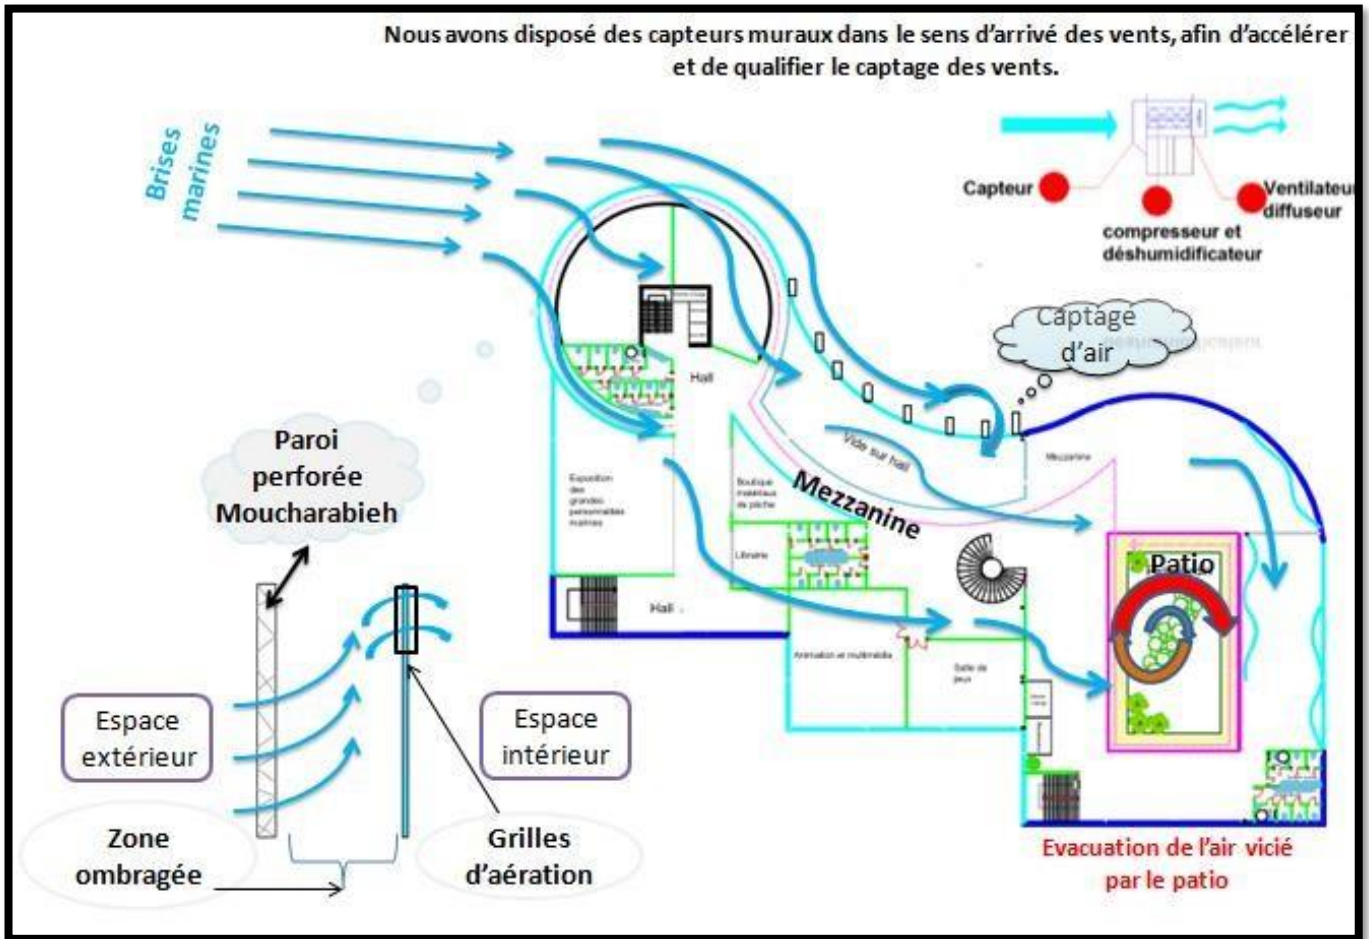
Plan schématique montrant le système de captage d'air par capteurs muraux et façade perforée
